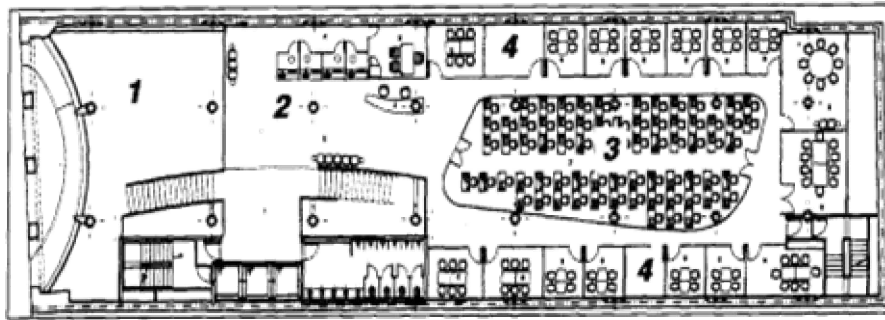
1- VACÍO SOBRE HALL. 2- HALL Y MINI BANCO.
